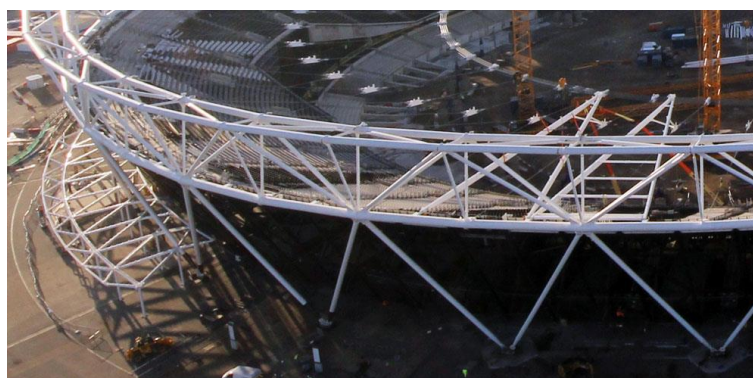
Construction de la toiture du The London 2012 main Olympic Stadium. [4]
